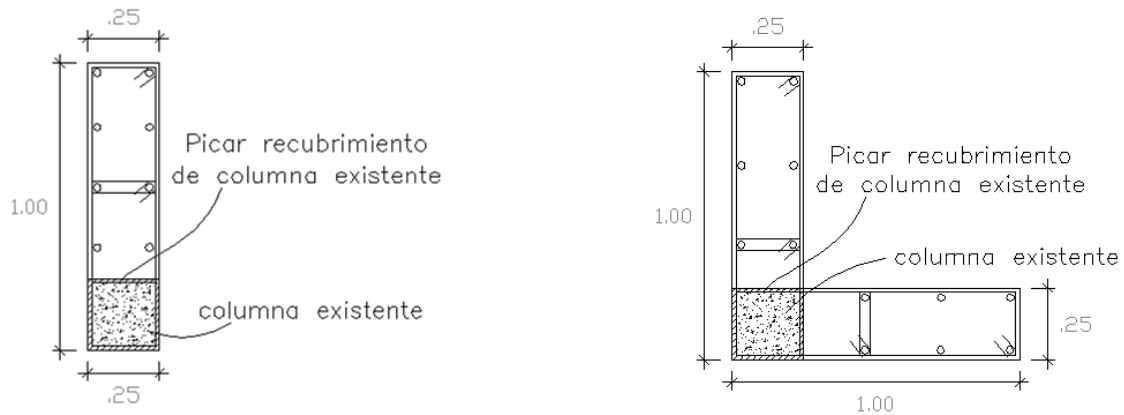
Detalle de reforzamiento para columna existente y esquinera.
